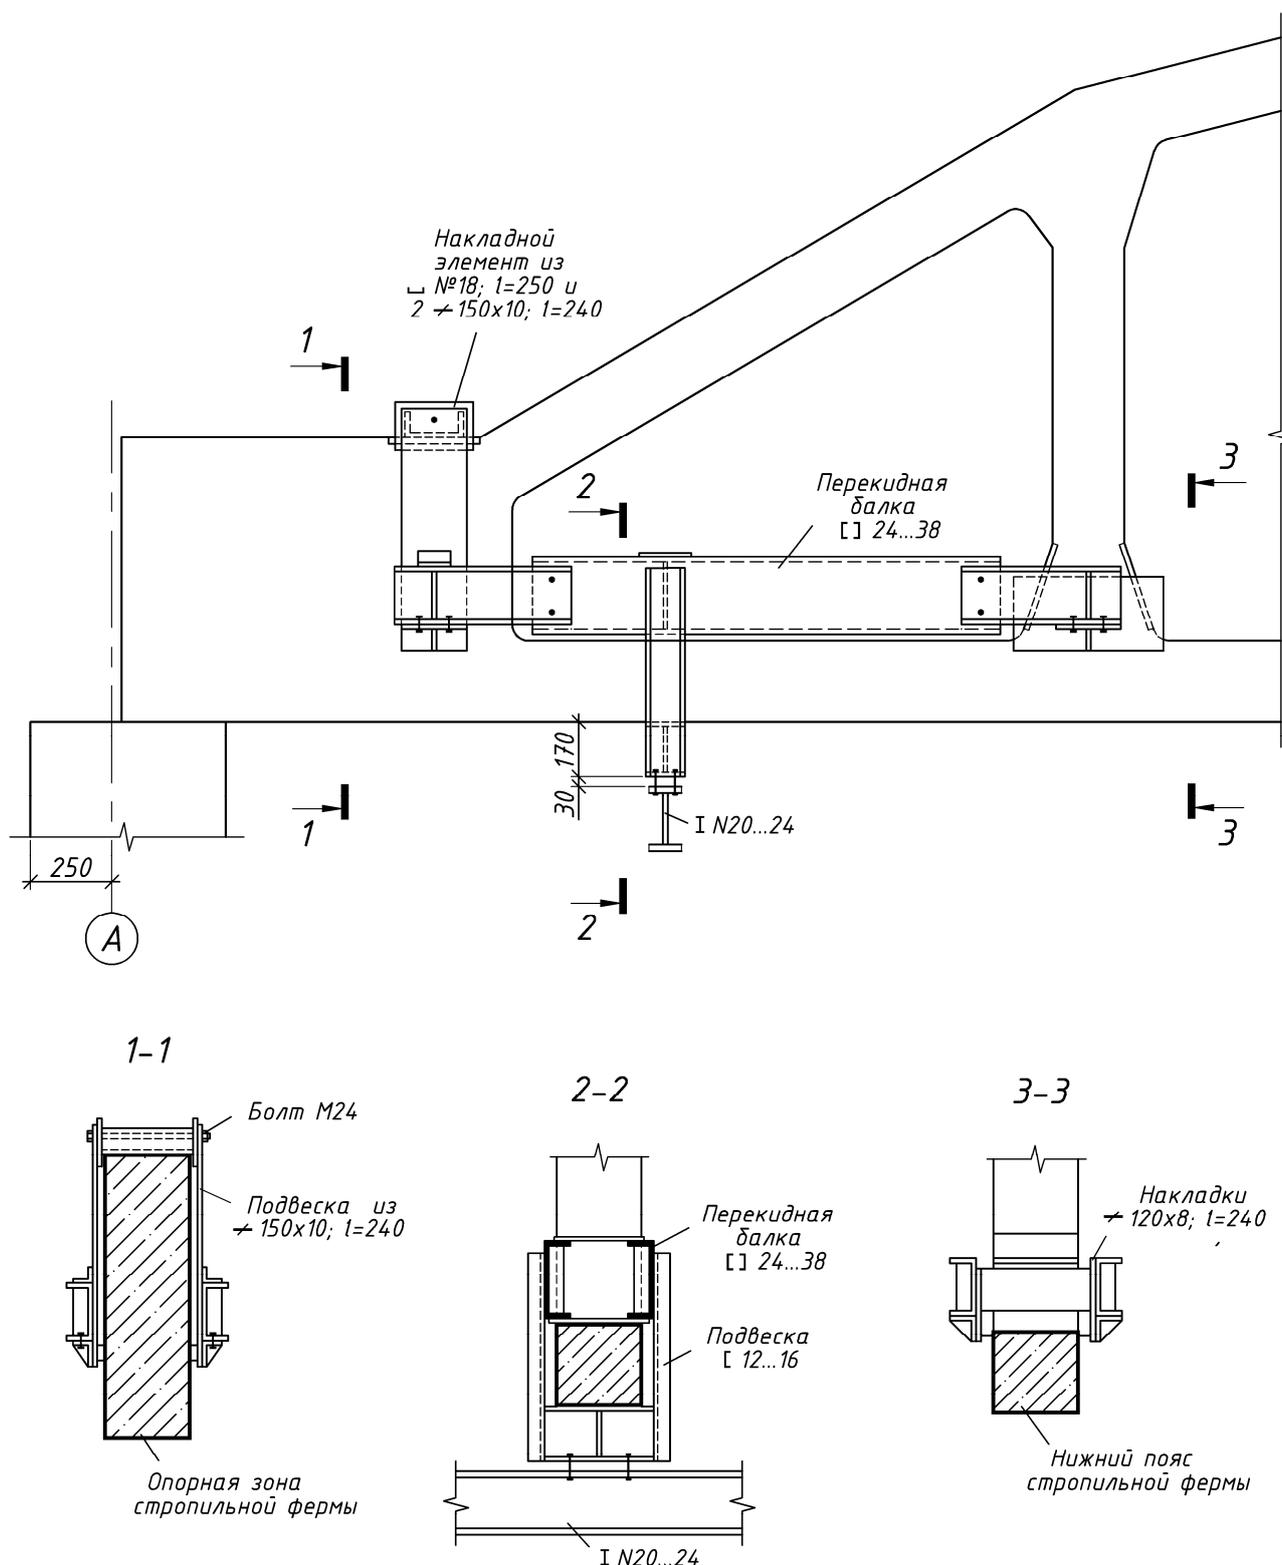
Конструктивные узлы подвески кранов с перекидными балками
